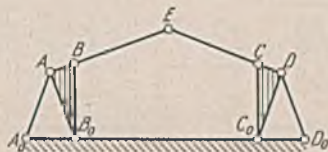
Durch Zweischläge gebildetes Scheibenfachwerk als mögliche Vorstufe zum Fachwerk der Abb. 1a.
